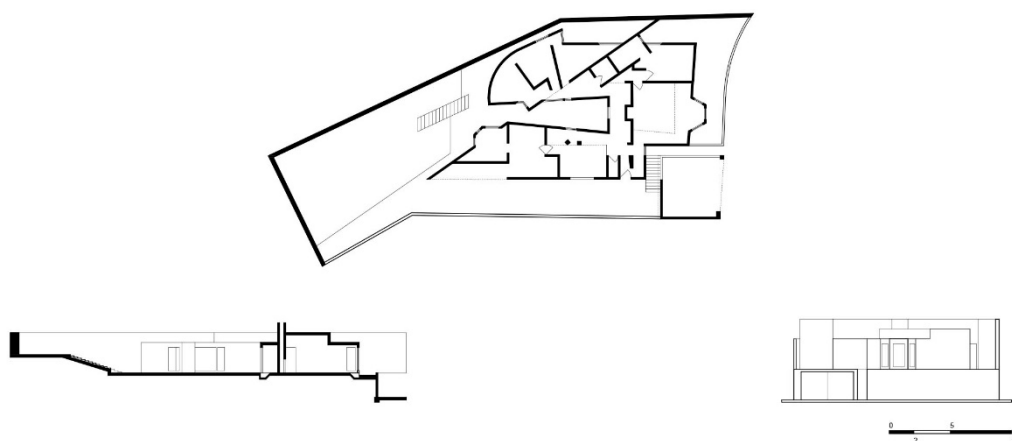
Redesenho da planta, corte e elevação – Casa Antônio Carlos Siza
